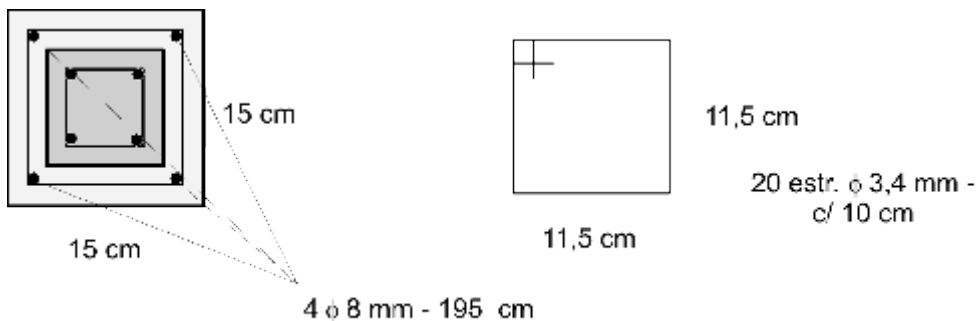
Seção transversal do pilar reforçado e armadura adicional.
